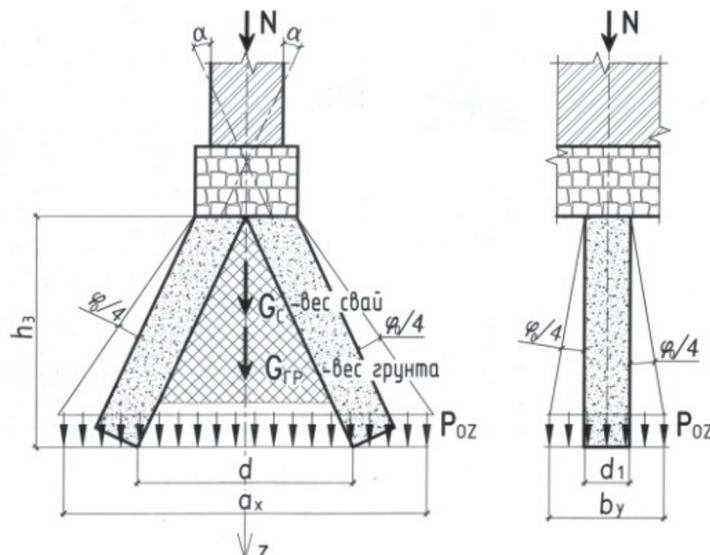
Расчетная схема усиления ленточного бутового фундамента
